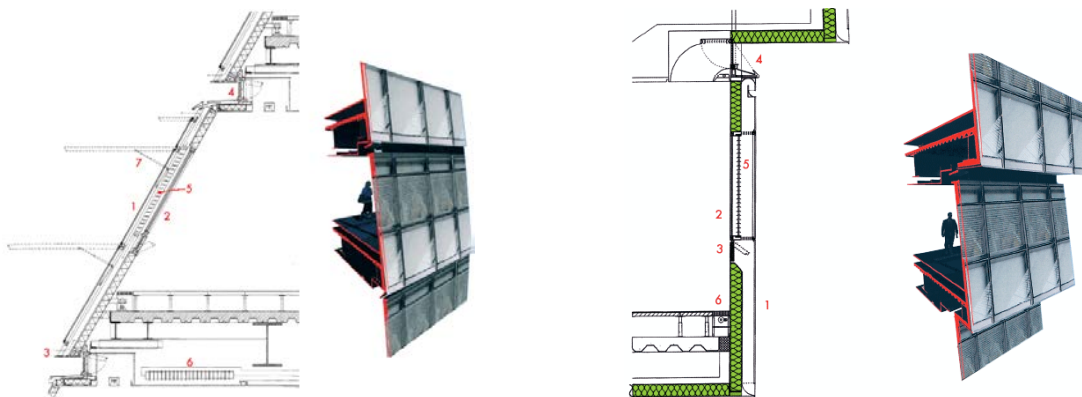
Схема монтажа светопрозрачных конструкций северного и южного фасадов [10].
